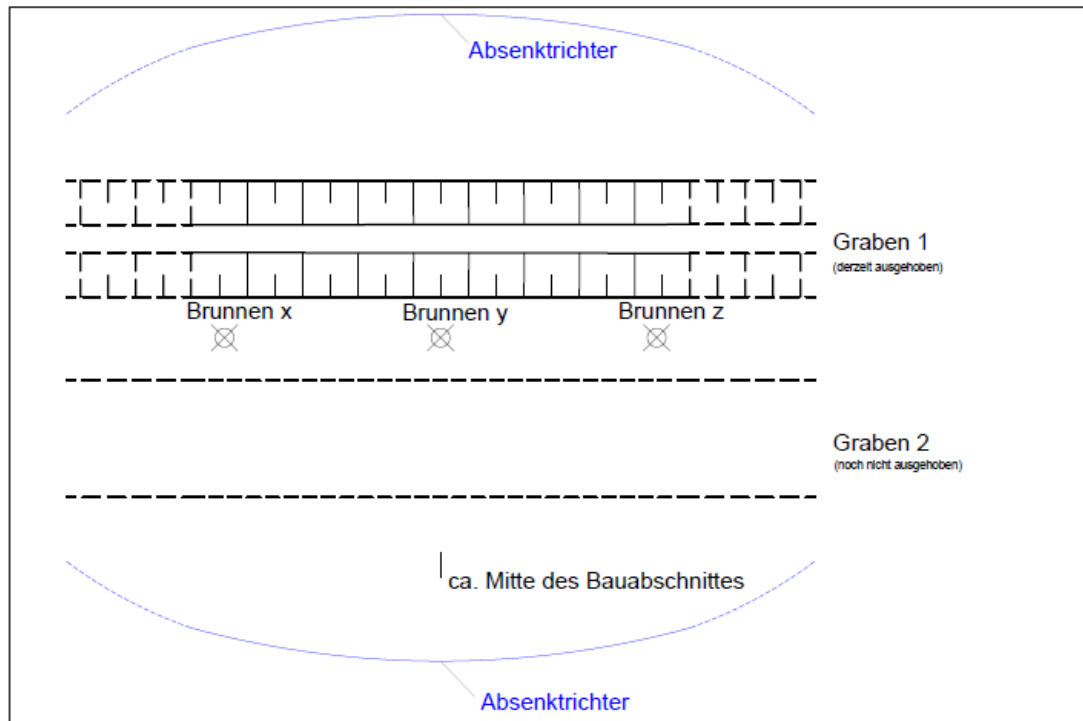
Prinzipskizze Grundwasserhaltung/-entspannung mit Brunnen im Grundriss
